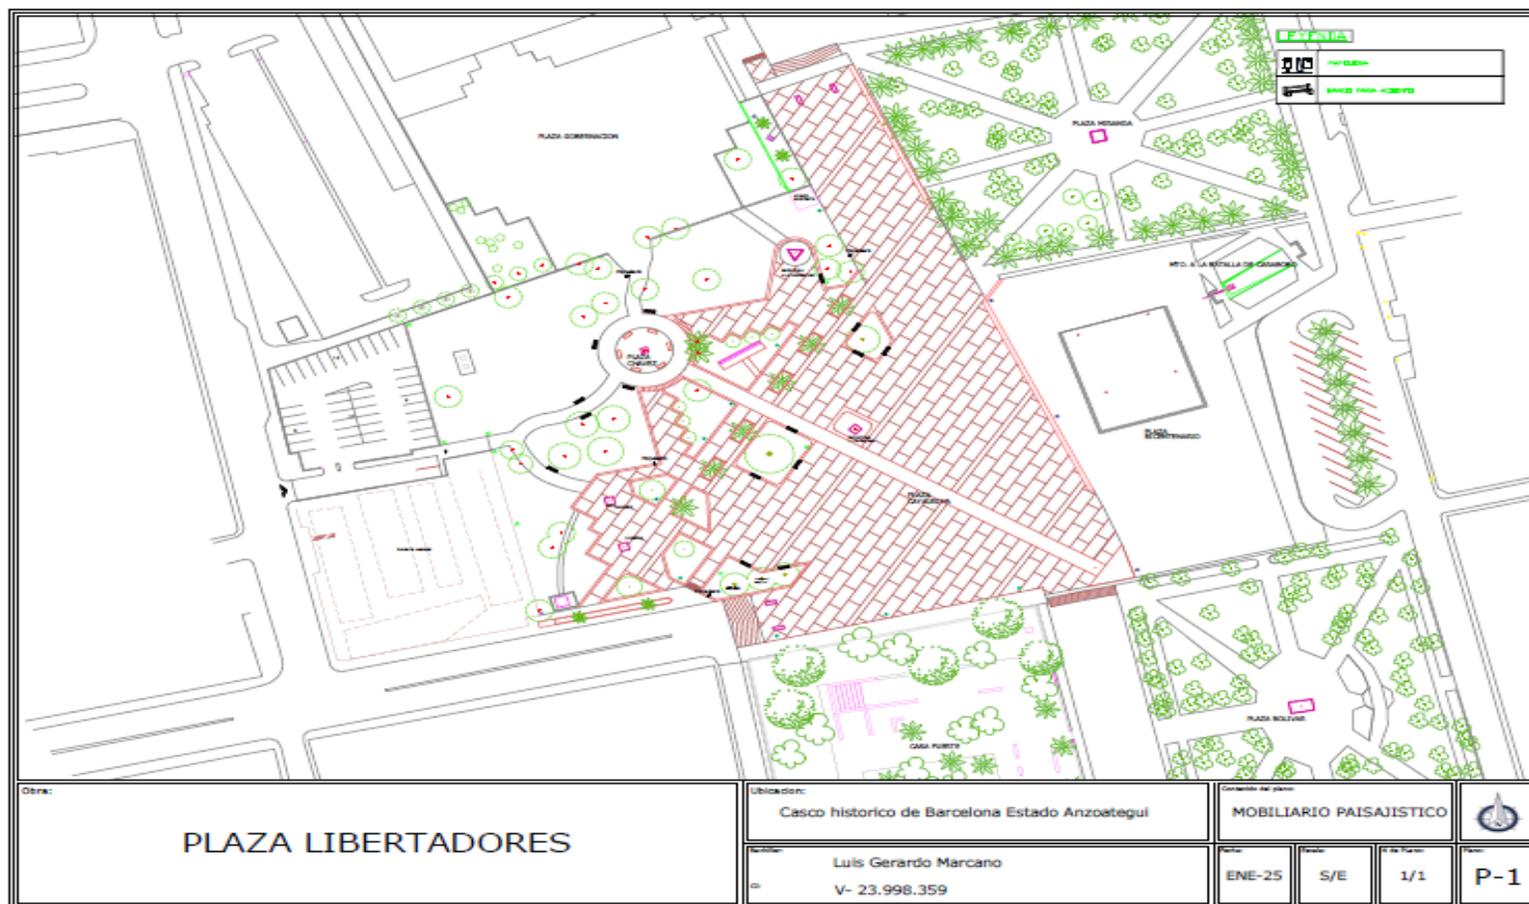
Plano propuesto de la instalación de los Bancos para las áreas nuevas, construidas en la plaza.. Fuente: Elaboración propia (2024).
